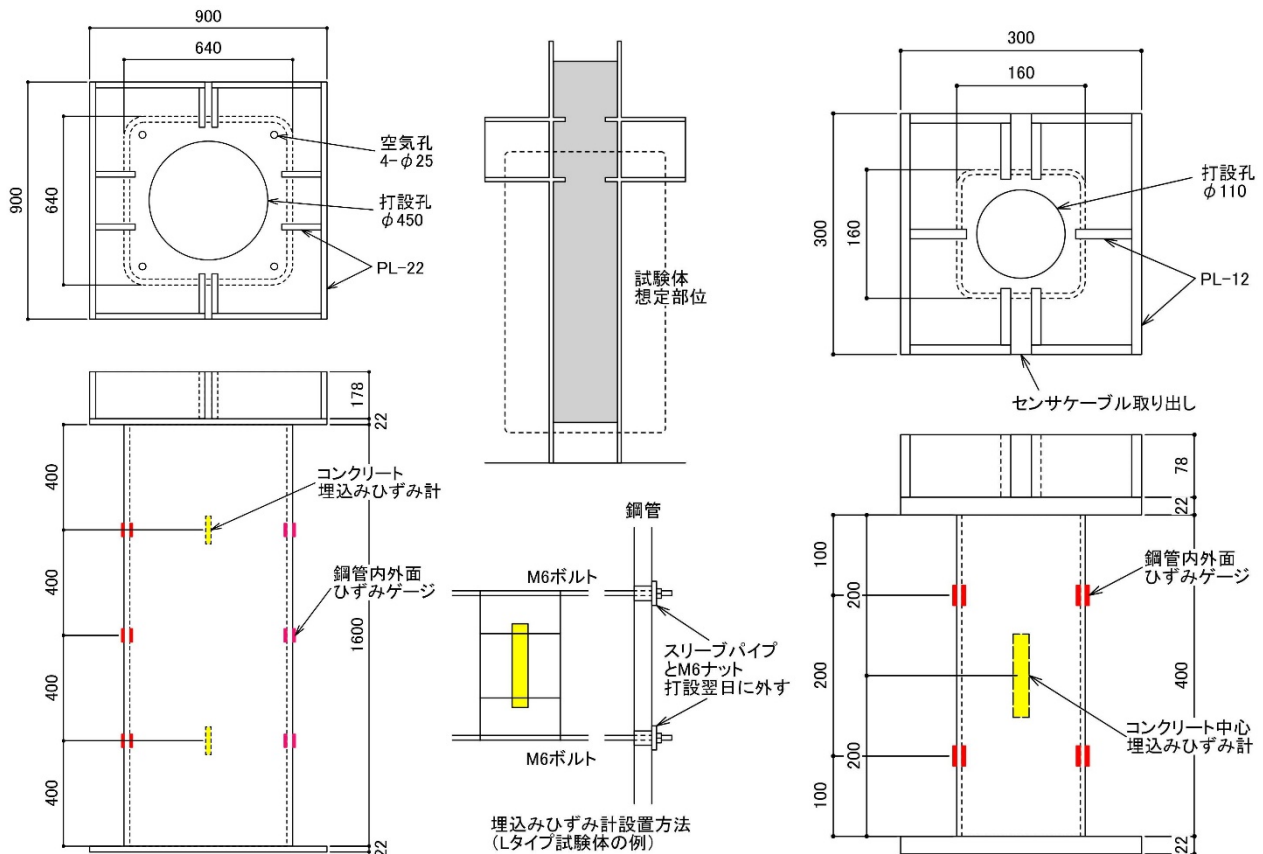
試験体の形状・寸法（左：Lタイプ、右：Sタイプ）
